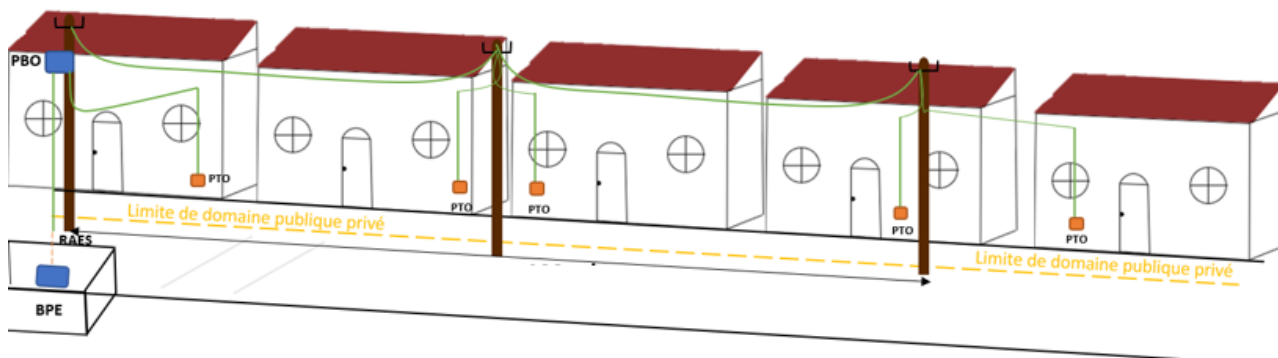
Schéma illustratif d'un raccordement depuis un PBO sur poteau
